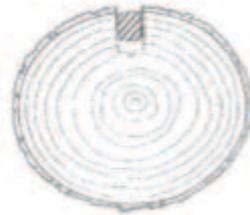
Positionnement d'une douille en coupe transversale ³¹
